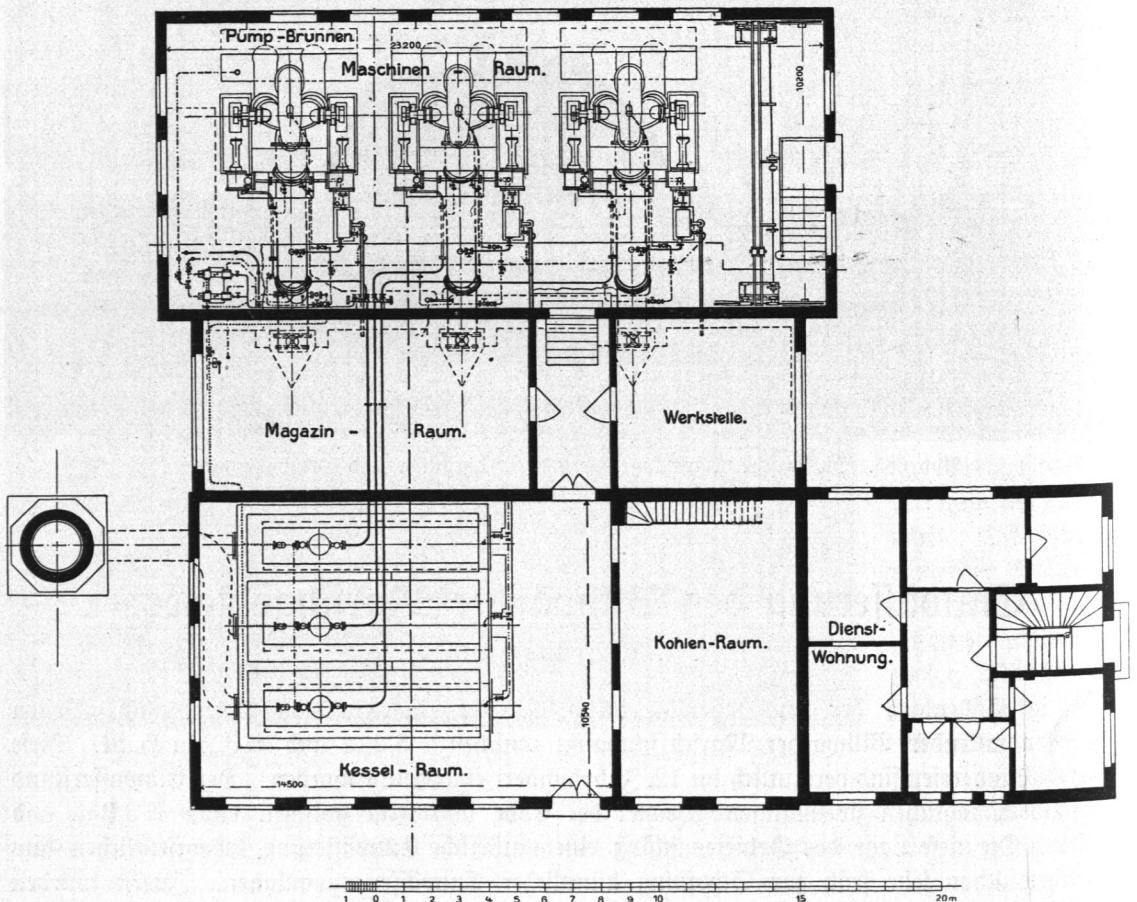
Pumpwerk Allermöhe, Grundriß.
